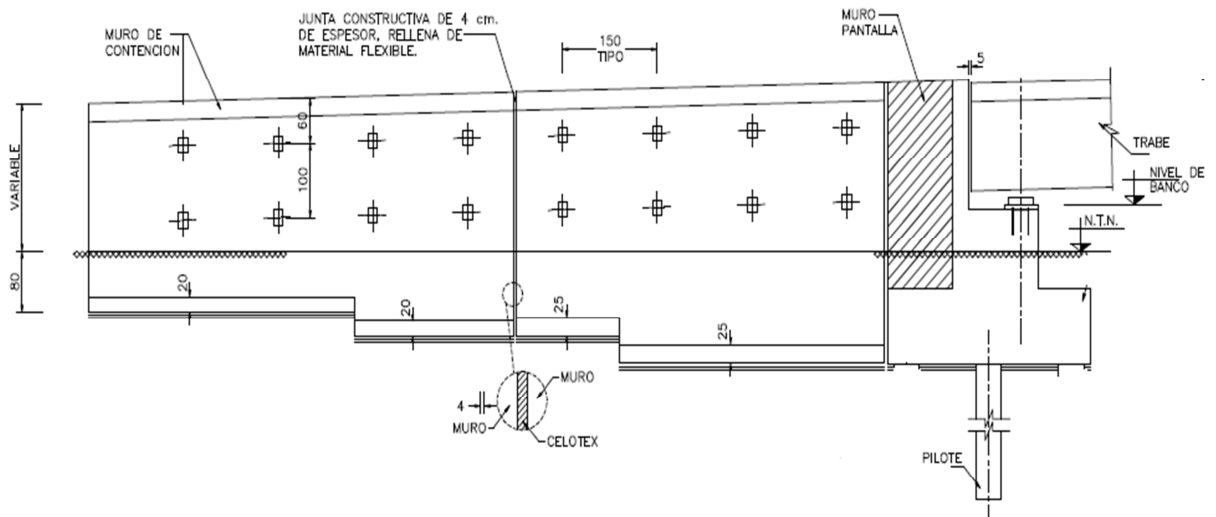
Excavación del terreno y armado de muros de contención
